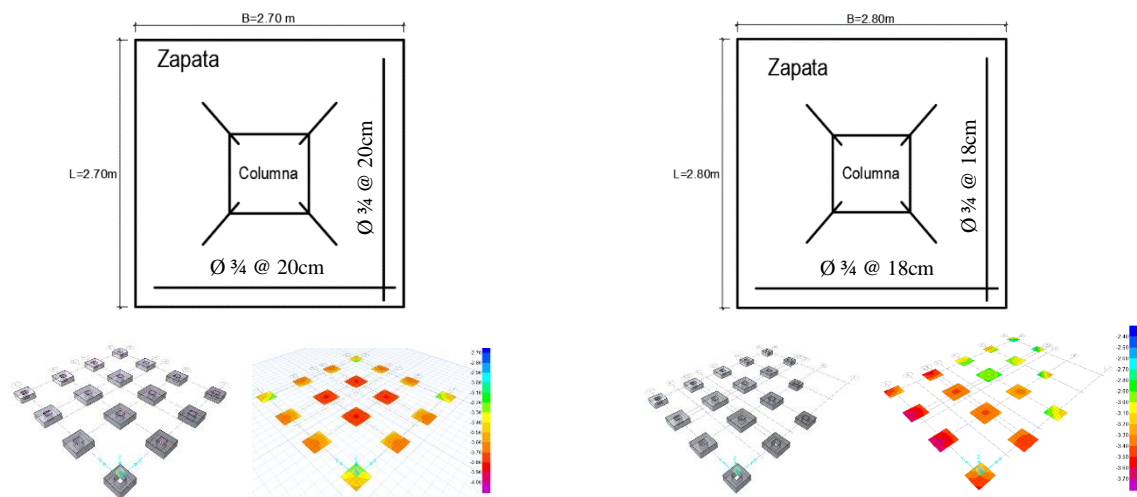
Zapatas aisladas centradas. a) estructura regular ejes (2-C). b) estructura irregular ejes (2-B). Fuente: El autor
